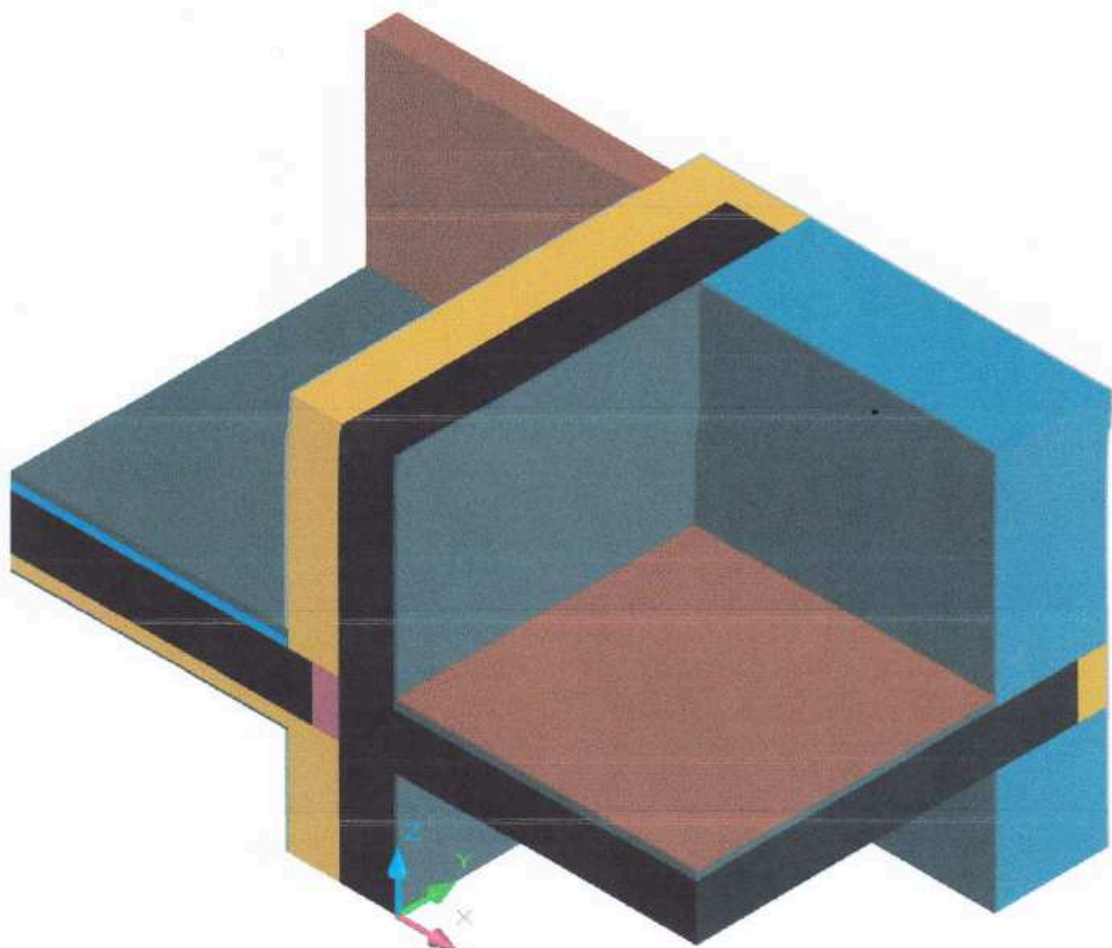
Расчетная схема узла сопряжения наружной стены и перекрытия (с перфорацией диска пенополистирольными плитами)
